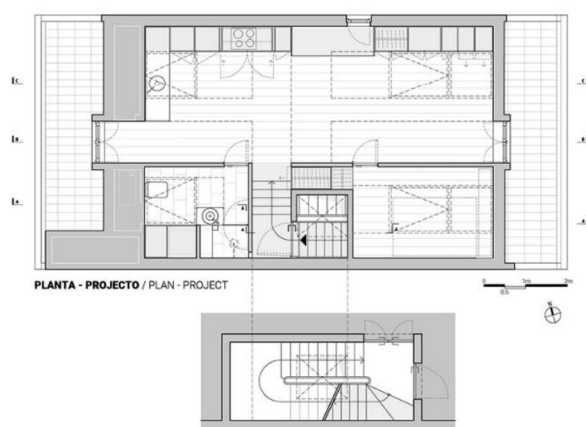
Planta Marvila Apartment. Fonte: KEMA studio.
